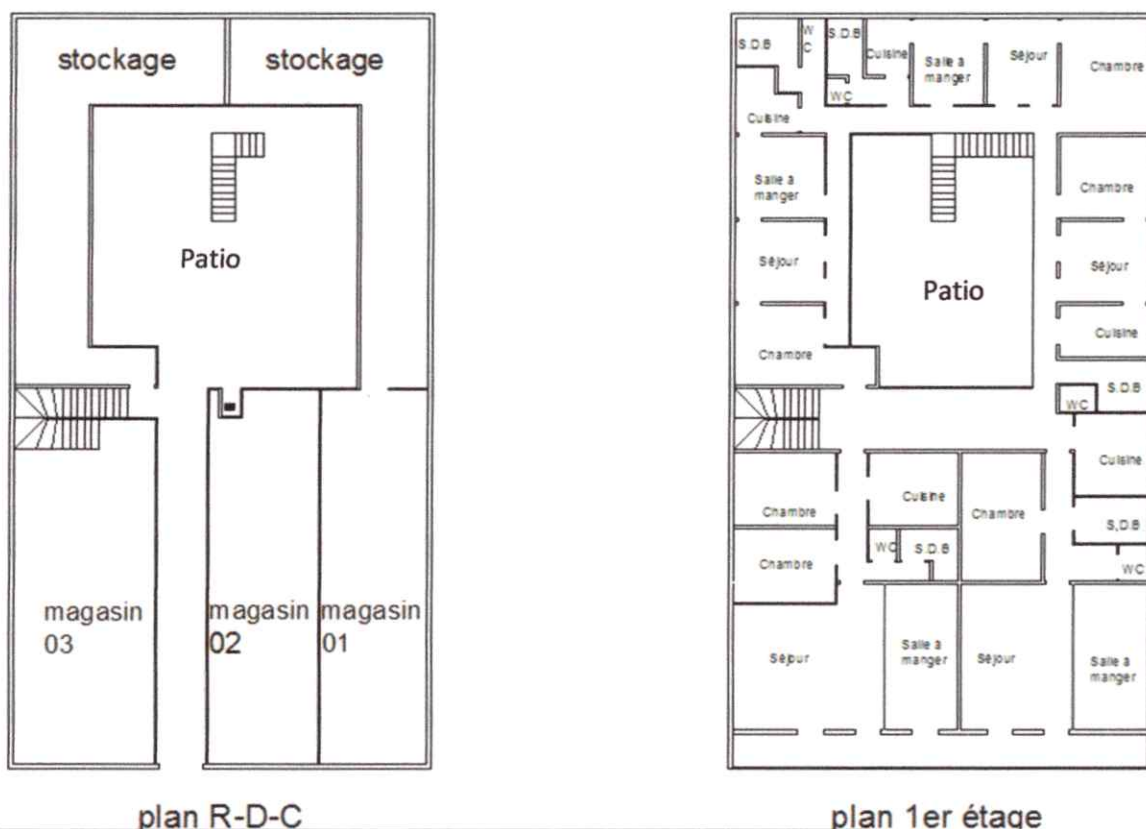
les plans d'Harat de R+1, source : relève faite par notre groupe en M1
